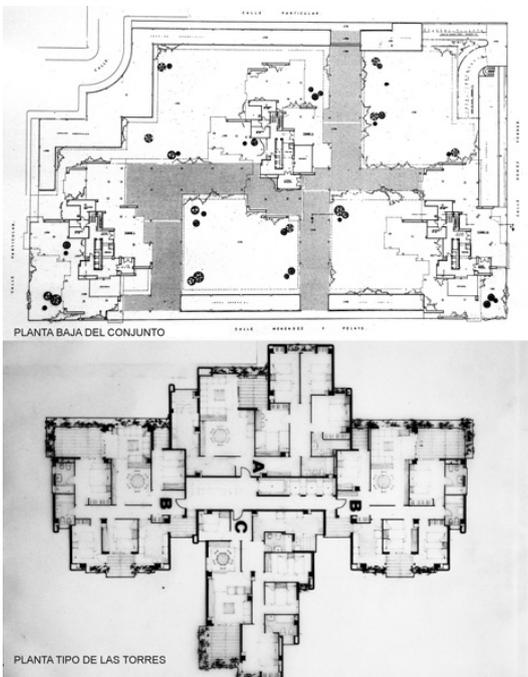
Planta baja del conjunto y planta tipo. Fuente: COACV
